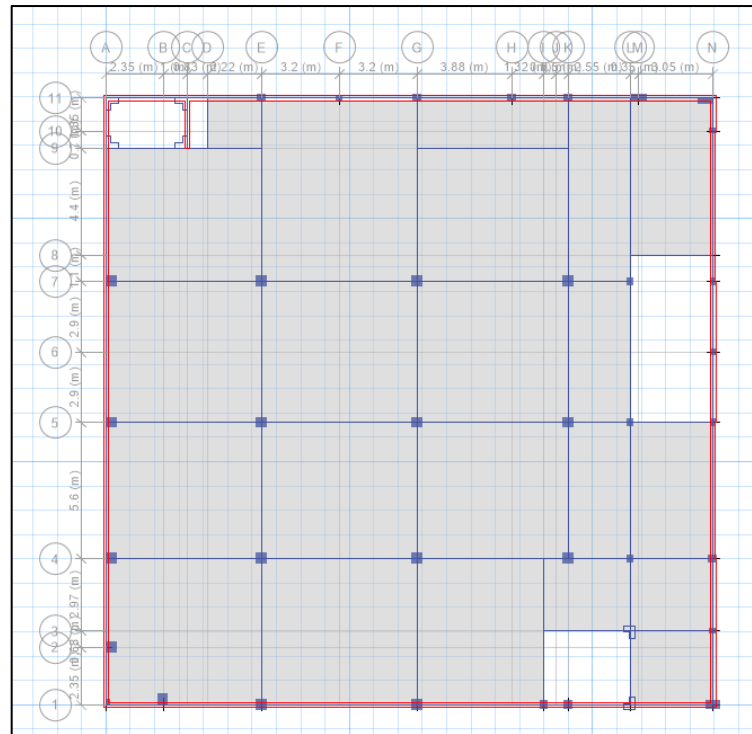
Modelo estructural elaborado en el software ETABS 16.2.1
